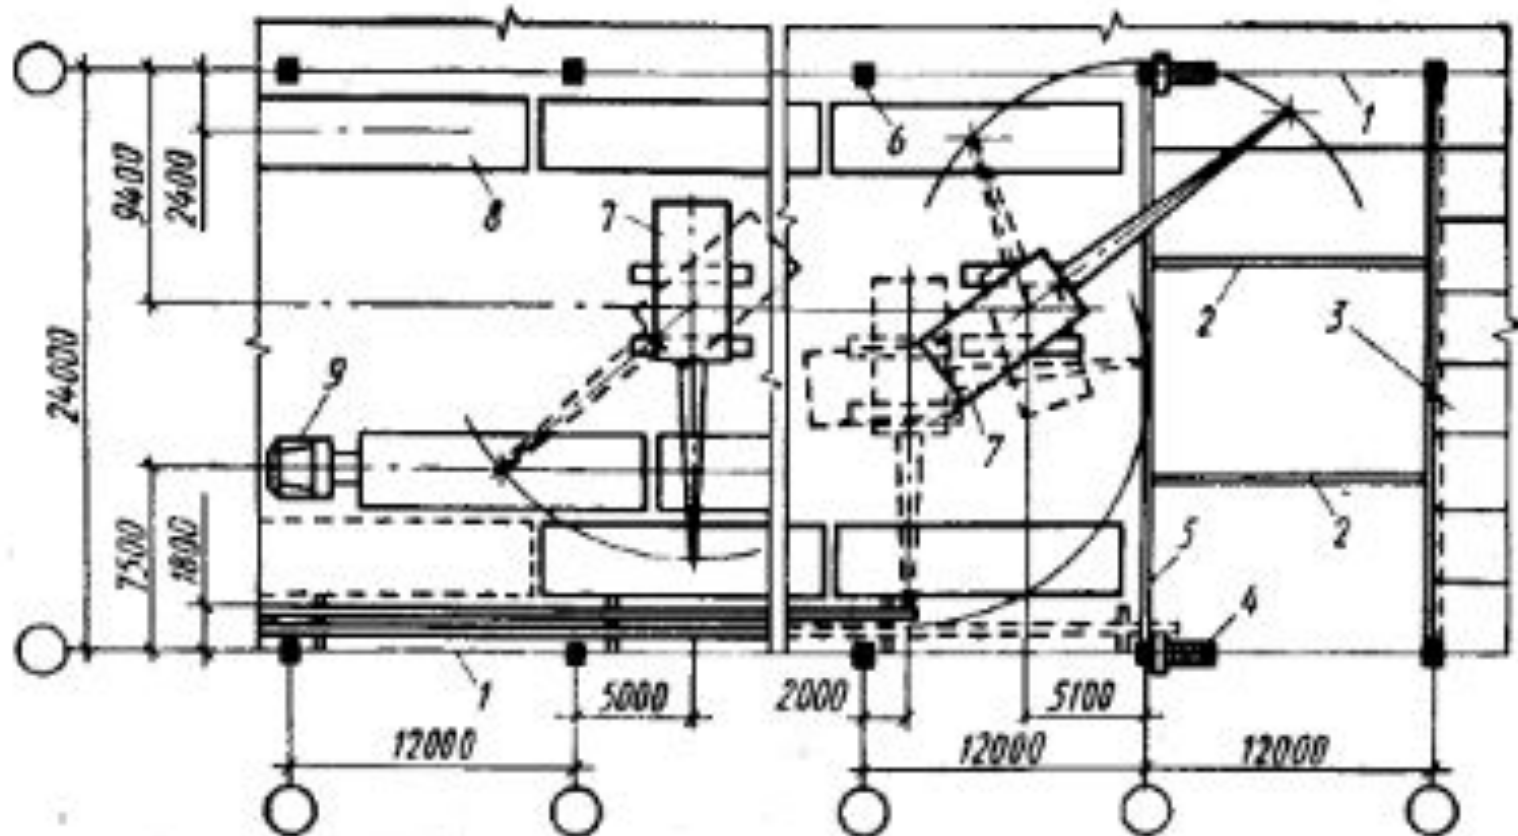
Схема выгрузки, раскладки элементов и монтажа покрытия пролетом 24 м, с шагом колонн и ферм 12 м продольным методом:
